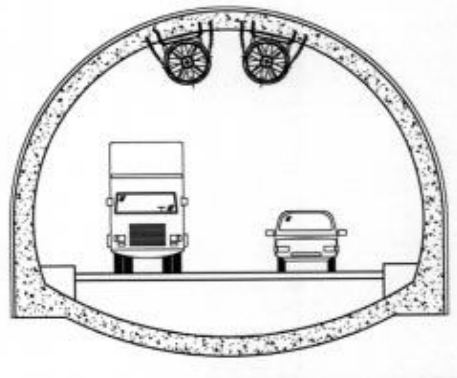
Esempio di sistema di ventilazione longitudinale con ventilatori a induzione
